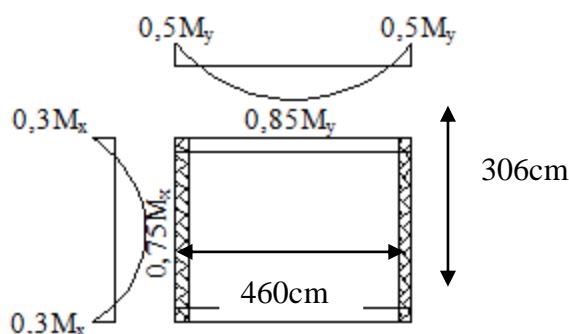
Schéma du panneau de la dalle appuyée sur 4 cotés.
